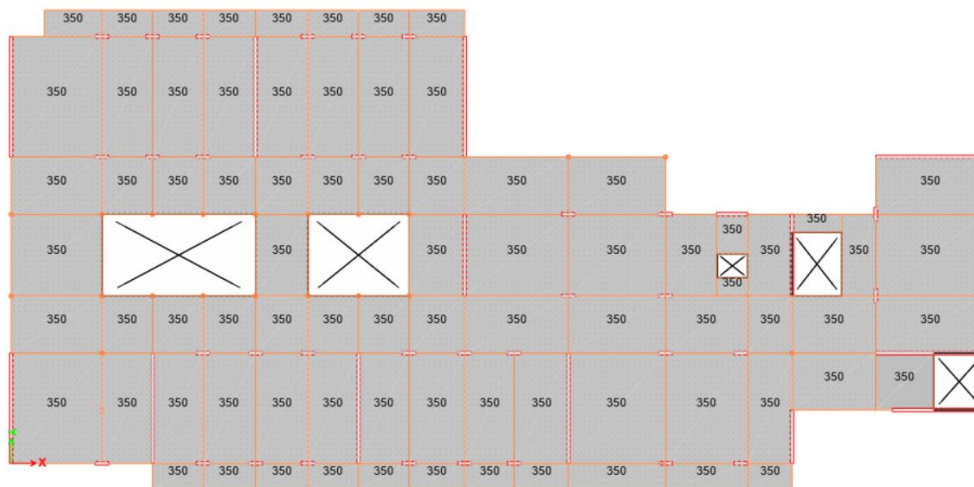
Cargas aplicadas por paño de losa en bloque de educación técnico productivo.
